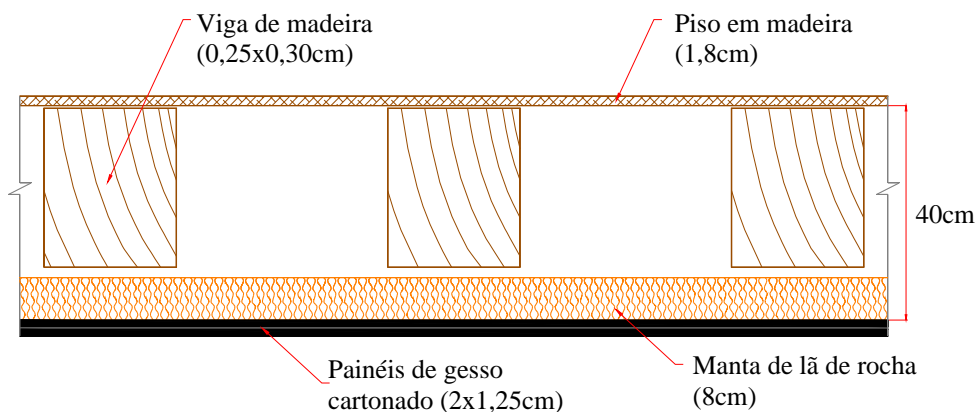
Pavimento de estrutura descontínua em madeira com tecto falso e isolante (Pav14)
